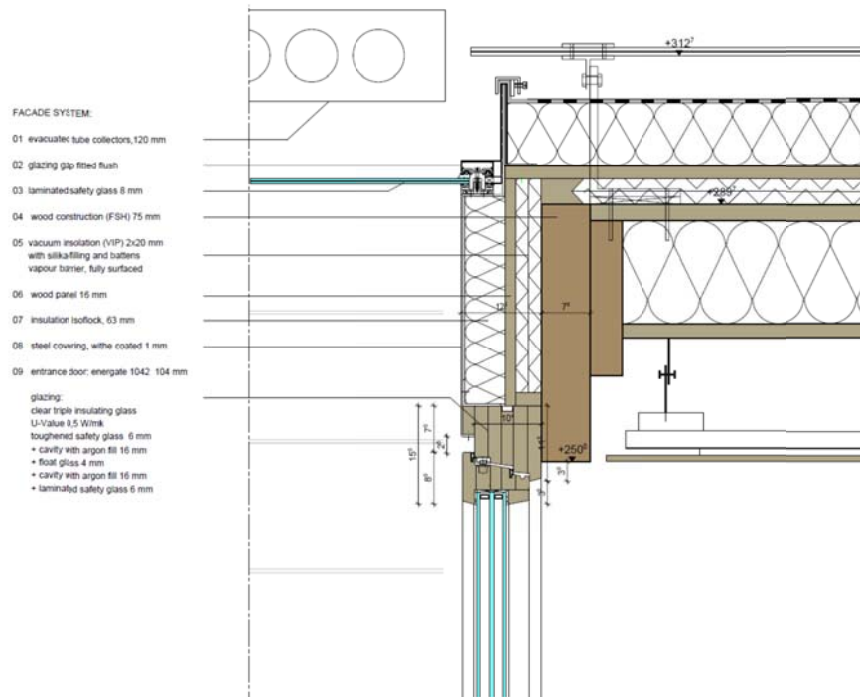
Sección encuentro con zona acristalada. Fuente: HFT_CD_2010-09-22
